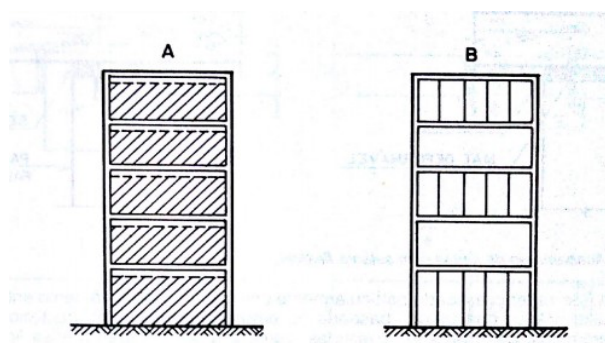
A) Paredes encunhadas a posteriori; B) Fechamento alternado das paredes.
